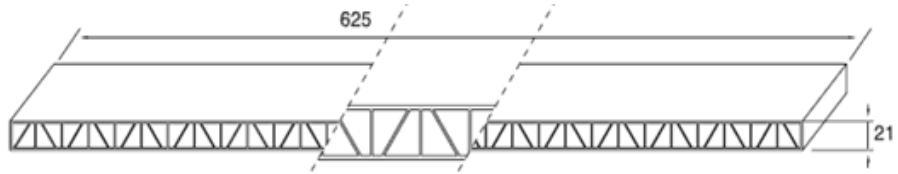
Pladeck döşeme 18 mm 470mm*2500mm*18mm
